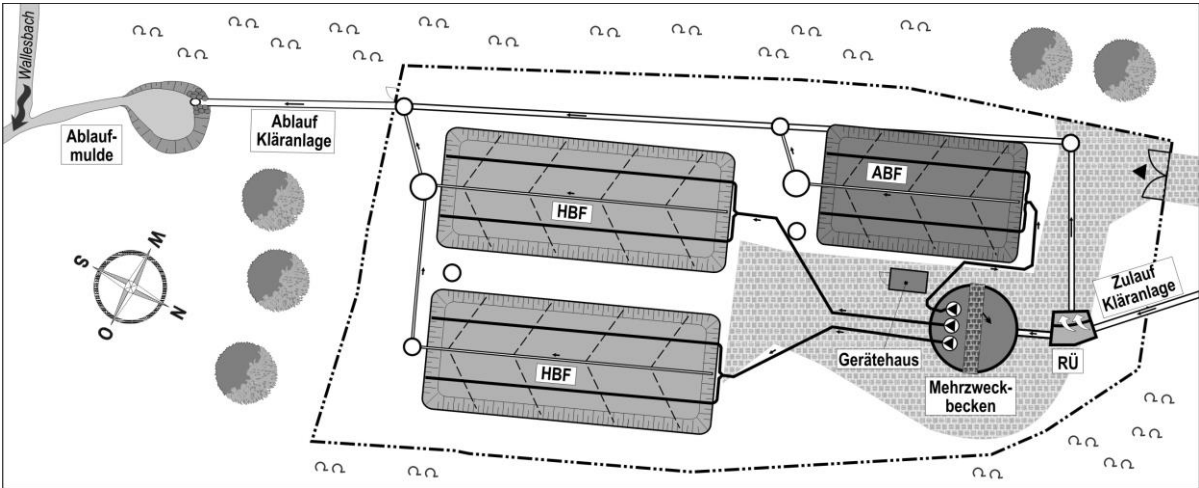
Lageplan zur Kläranlage Heisterberg
